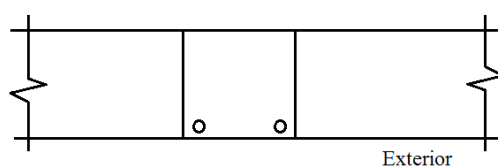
Disposição de armaduras na face exterior do pilar, Tipo I.
